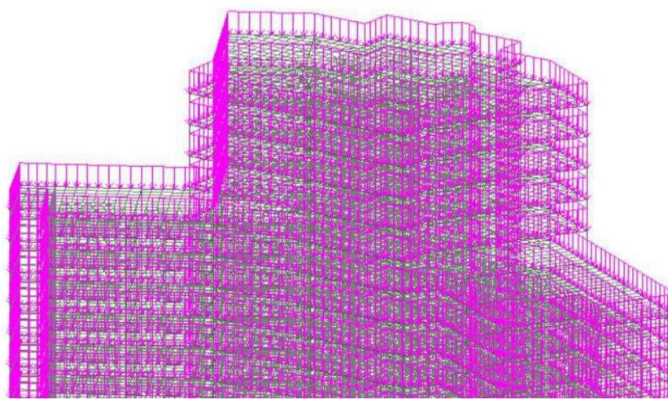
Навантаження від фасадного скління (по всій висоті будівлі)
